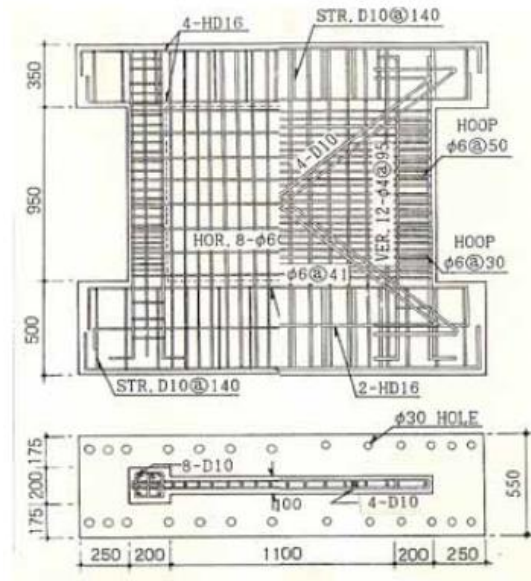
Detalle de refuerzo de muros (Choi et al. 2006)
